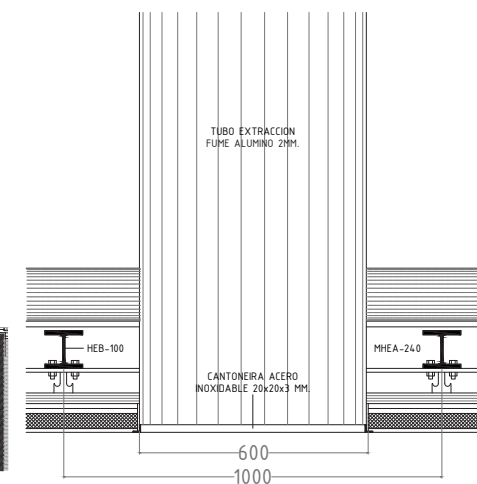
Detalle do extractor de fumes no seu encontro co techo. Escala 1/20.
